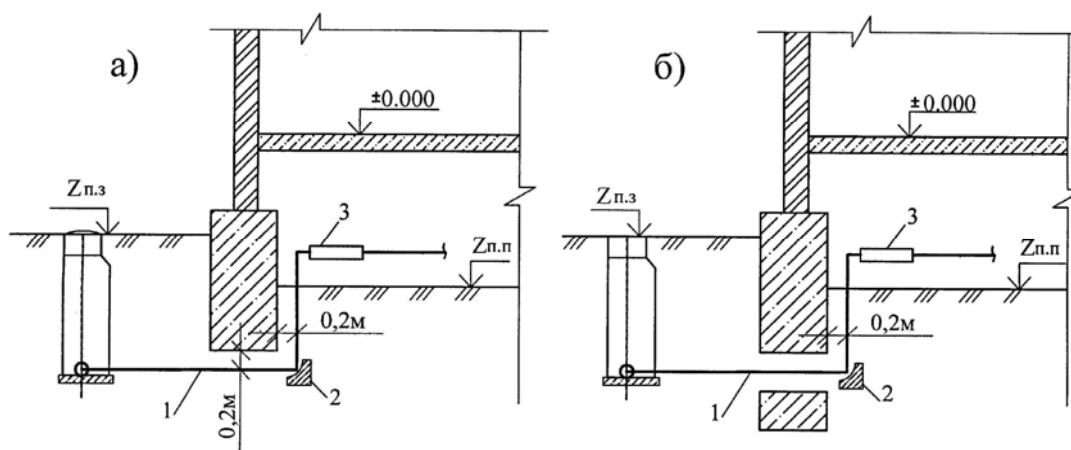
Схемы прокладки ввода ниже фундамента (а) и через фундамент (б):
